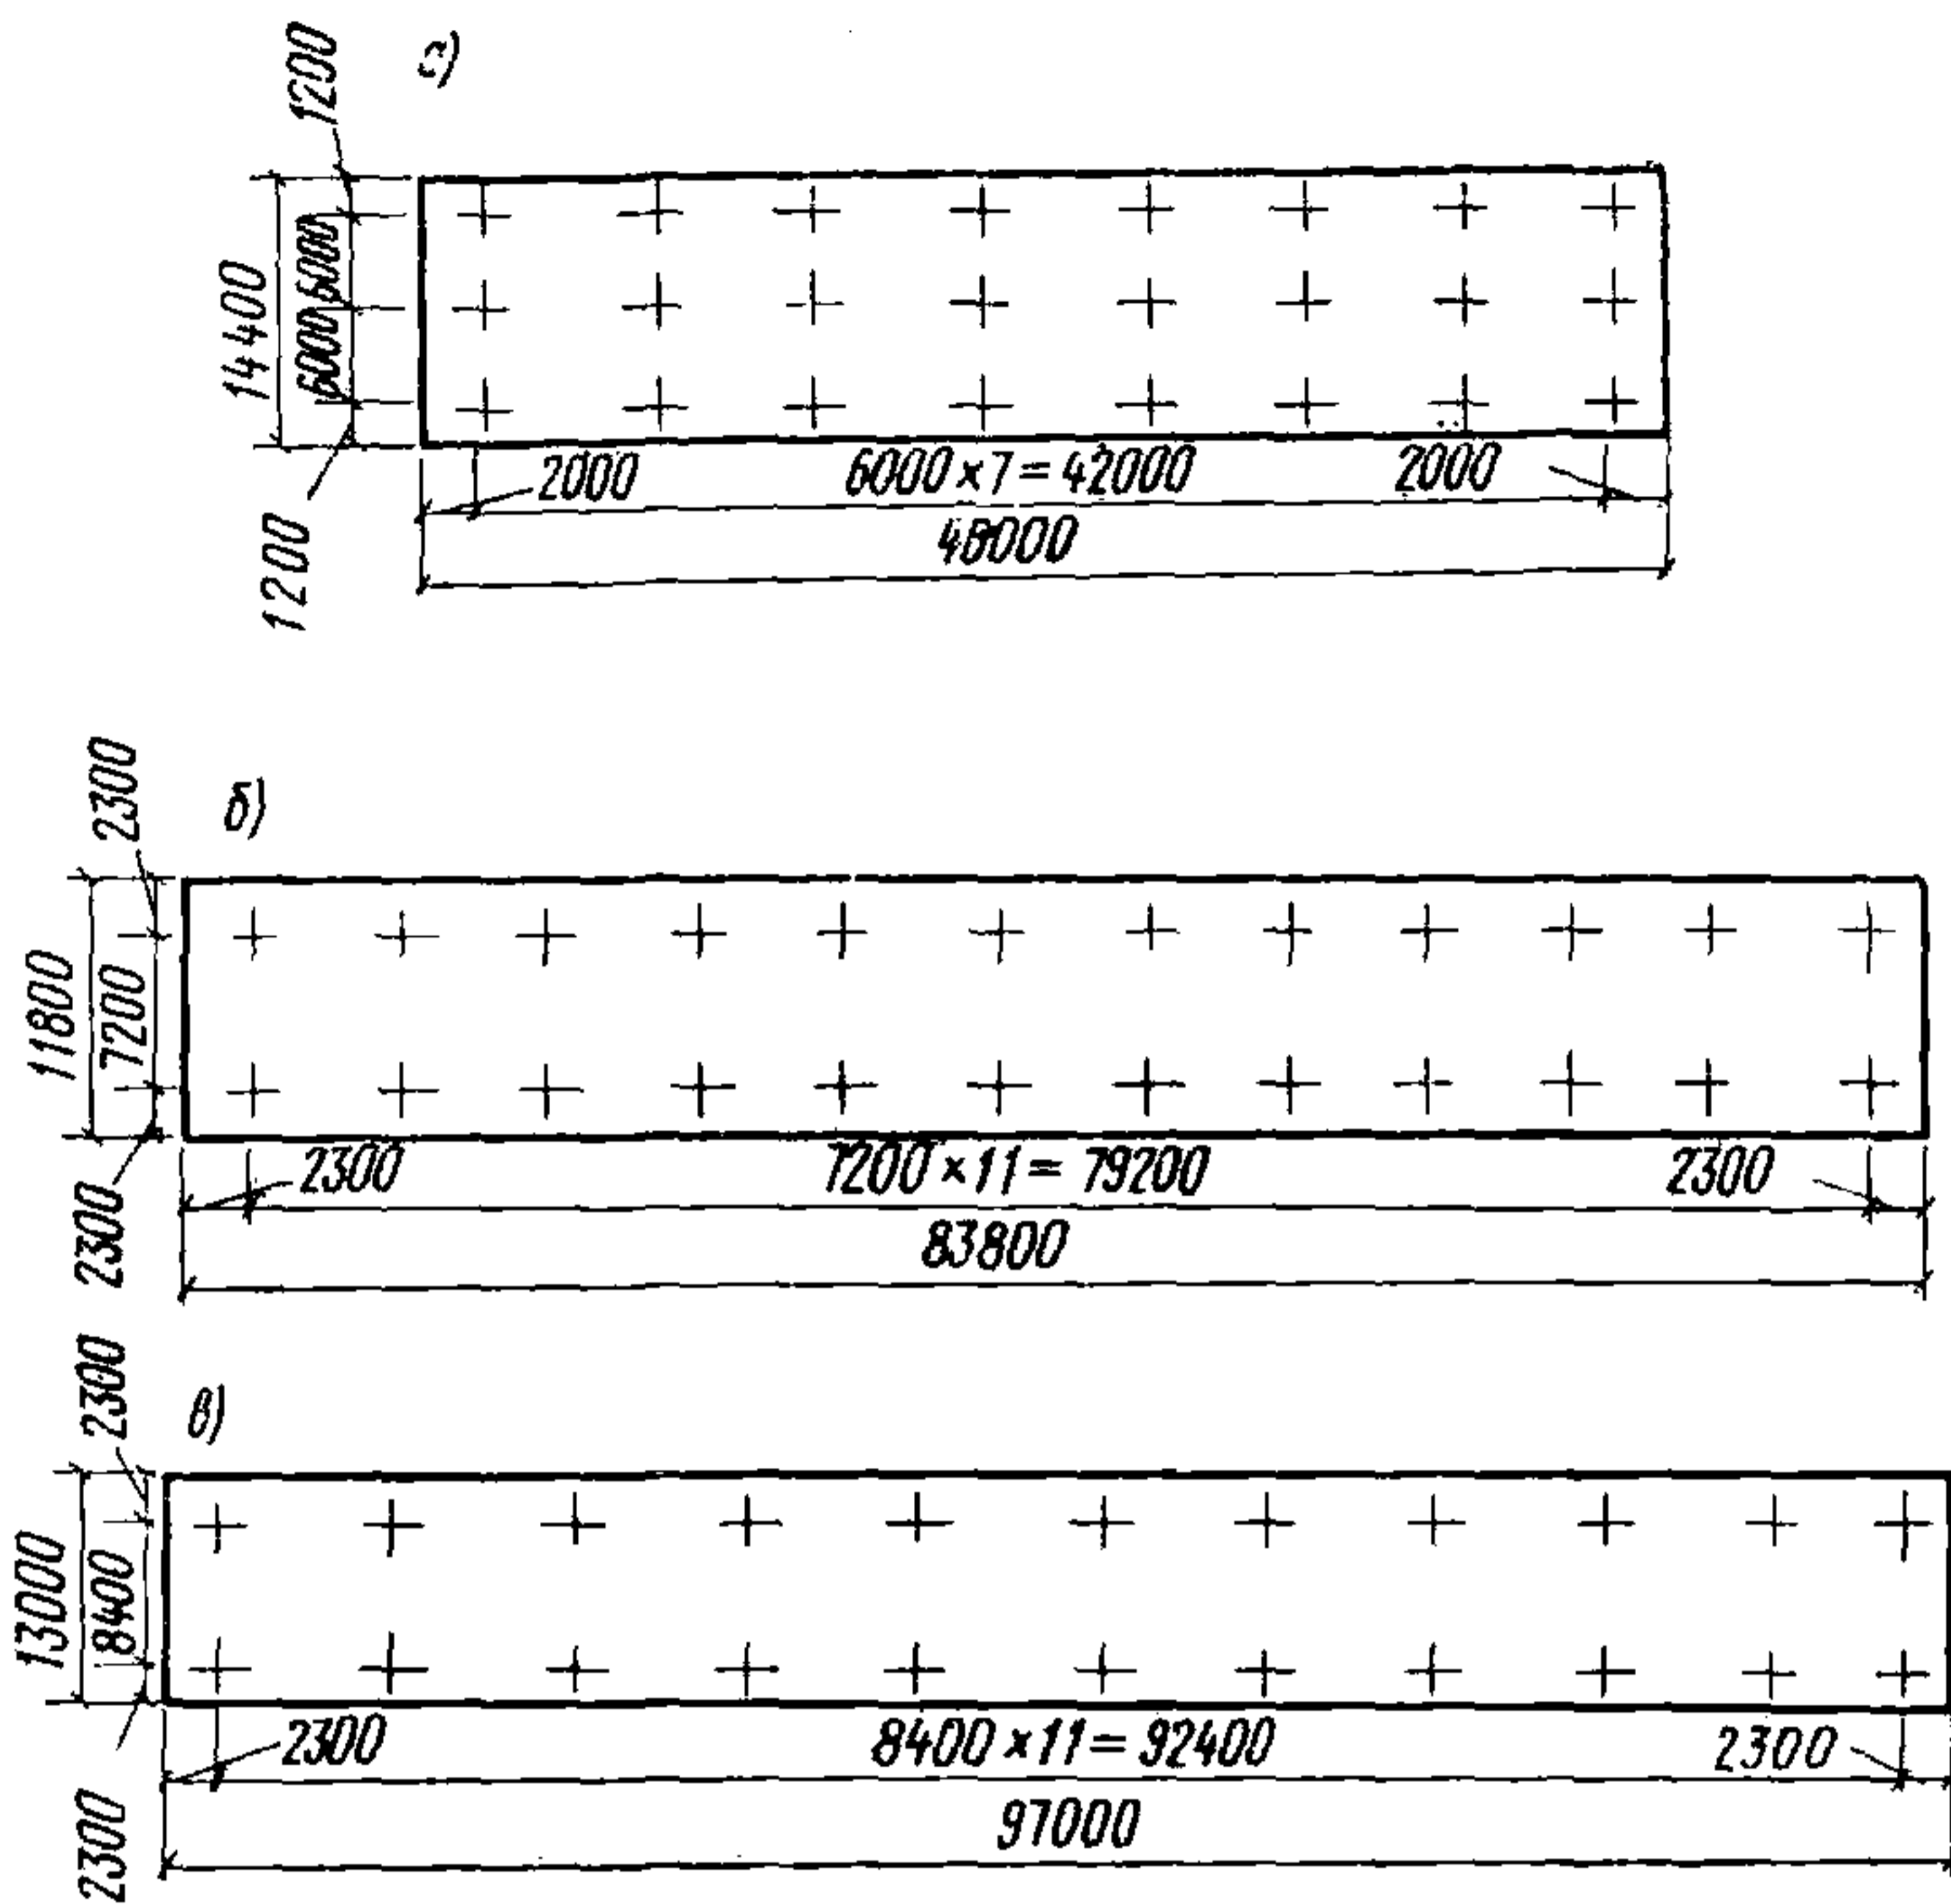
Расчетные схемы неразрезных безбалочных плит перекрытий с квадратной сеткой колонн
